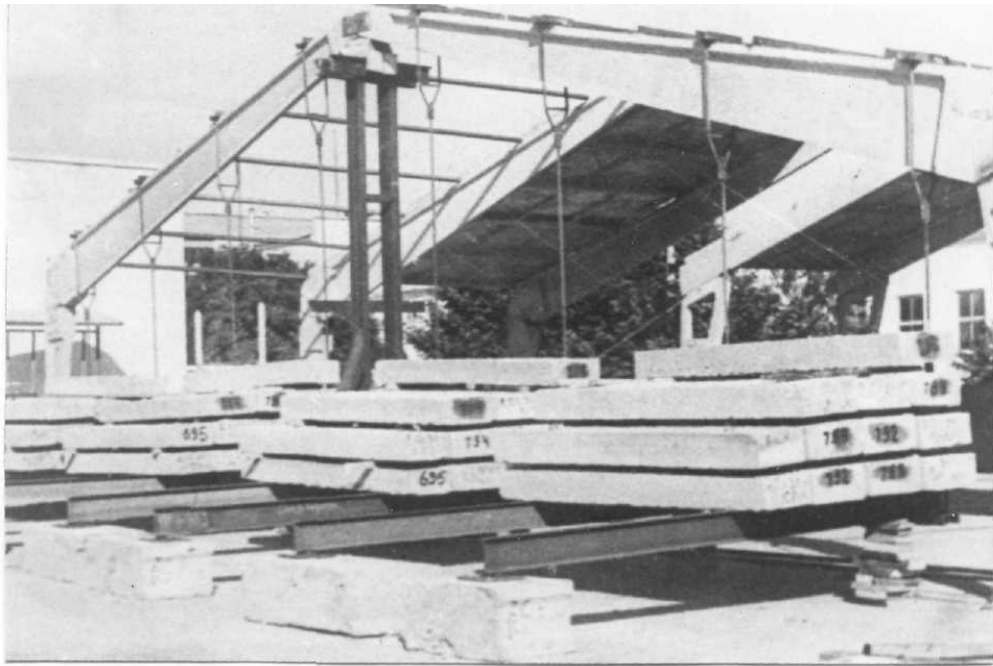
Завантаження рами РЖС-21-1600 штучними вантажами на заводі ЗБК к. комбінату Сільбудіндустрія Кримського Облміжколгоспбуду
